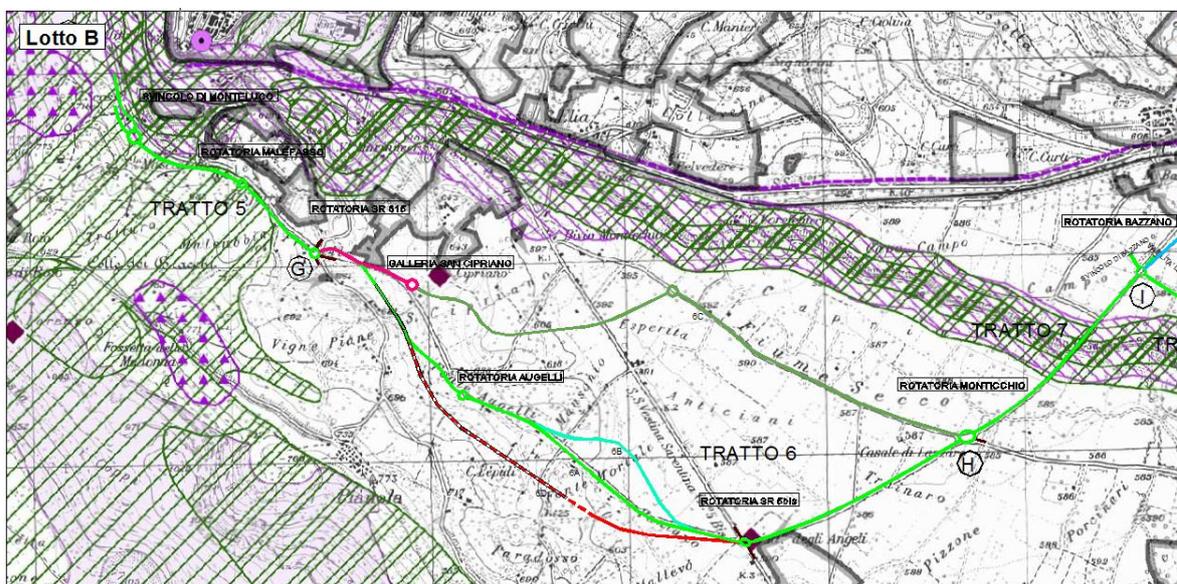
Stralcio planimetrico estratto dal P.R.P. in fase di approvazione con evidenza del tracciato di progetto e le alternative progettuali
